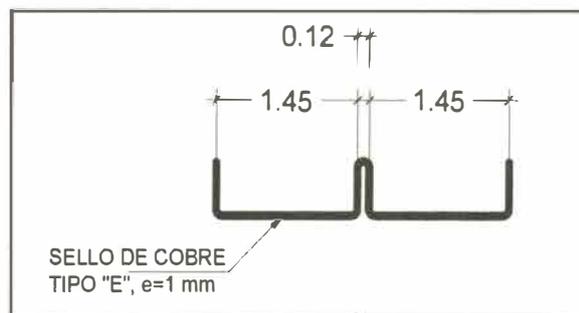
Detalle del sello de cobre utilizado en las juntas verticales
